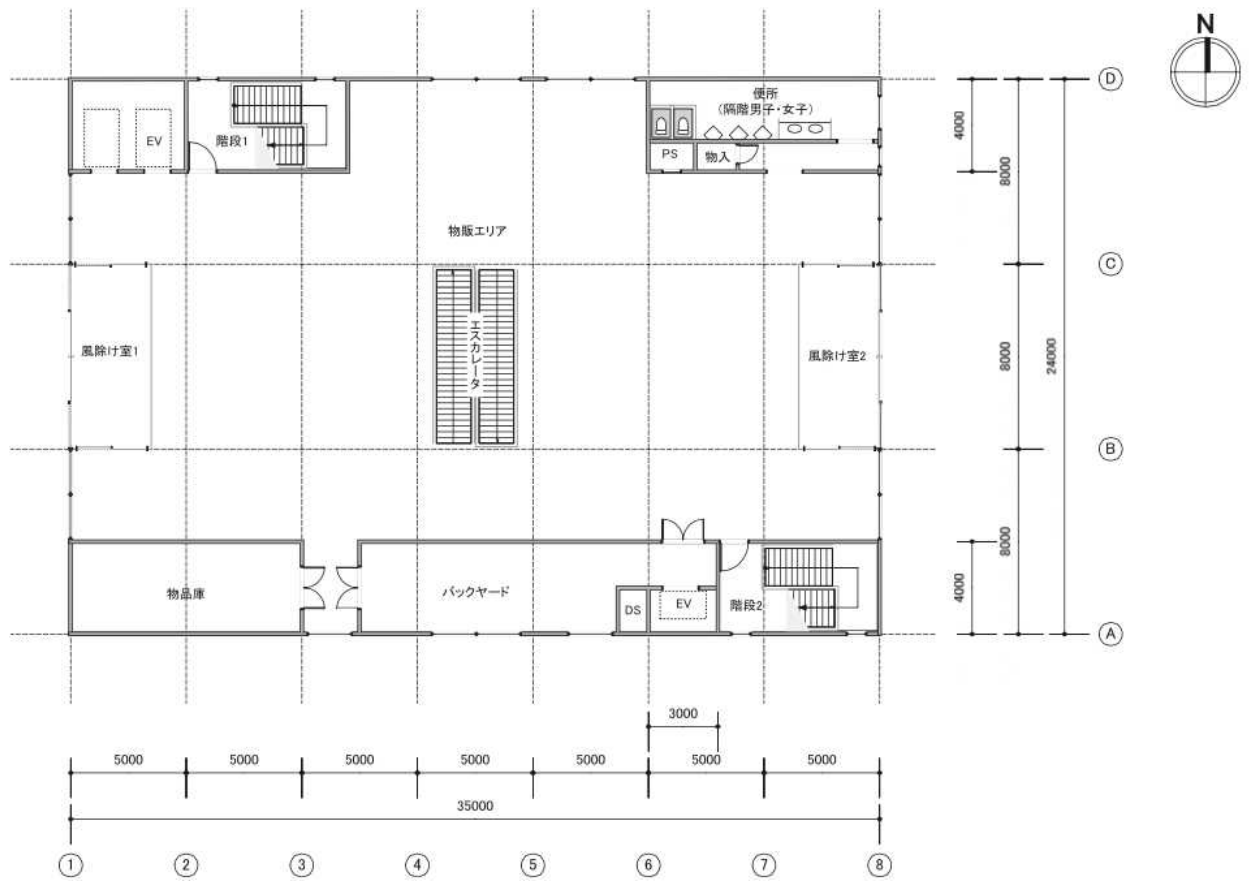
5 モデル建物（大規模物販店舗等） 1階平面図
